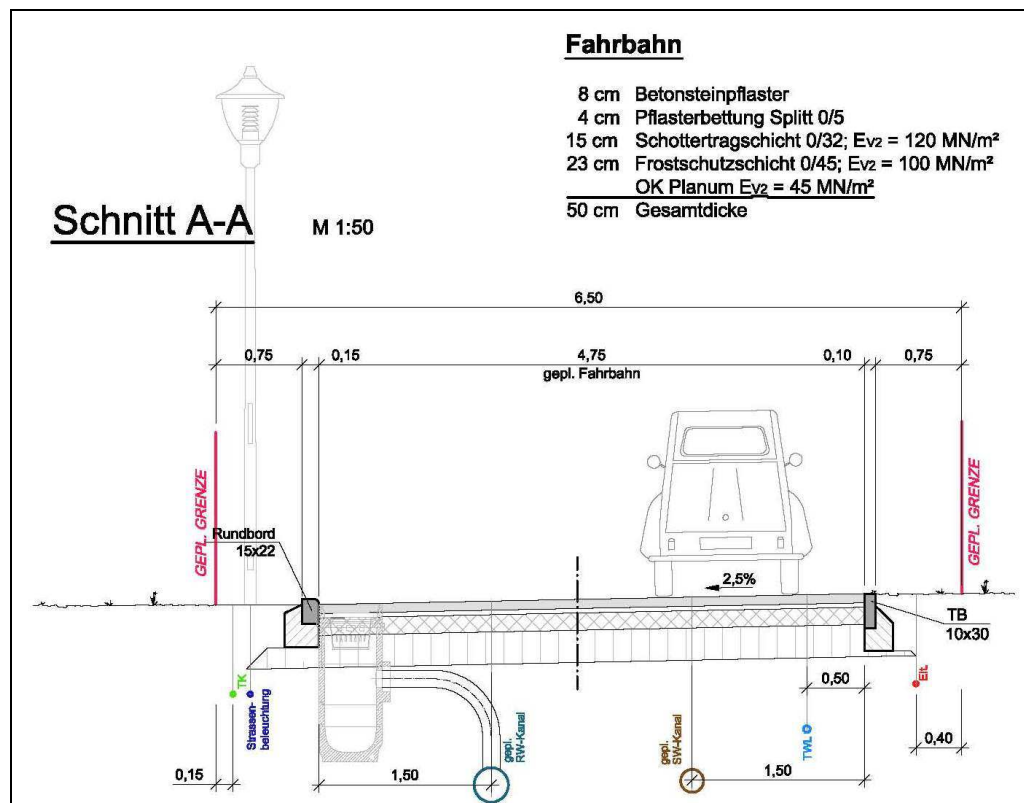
Regelschnitt für die geplanten öffentlichen Anwohnerstraßen; Grundlage Straßenplanung Büro LIVT 11/2015
